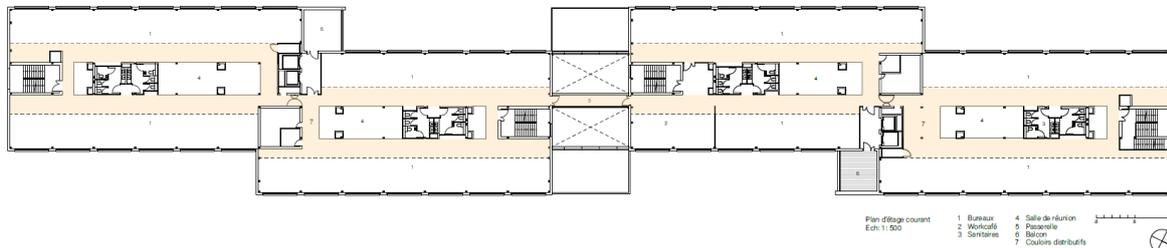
Plan d'étage courant. ©ArtBuild Architects
